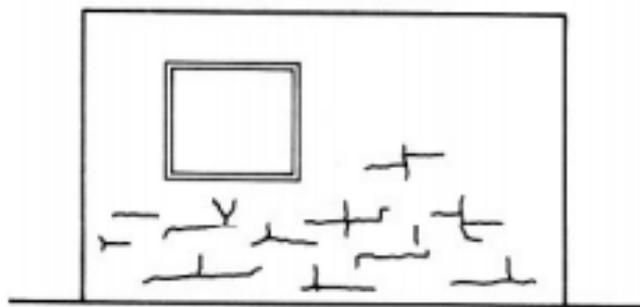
Fissuras horizontais no revestimento provocadas pelo ataque de sulfatos. Fonte: Thomaz, 1989.
